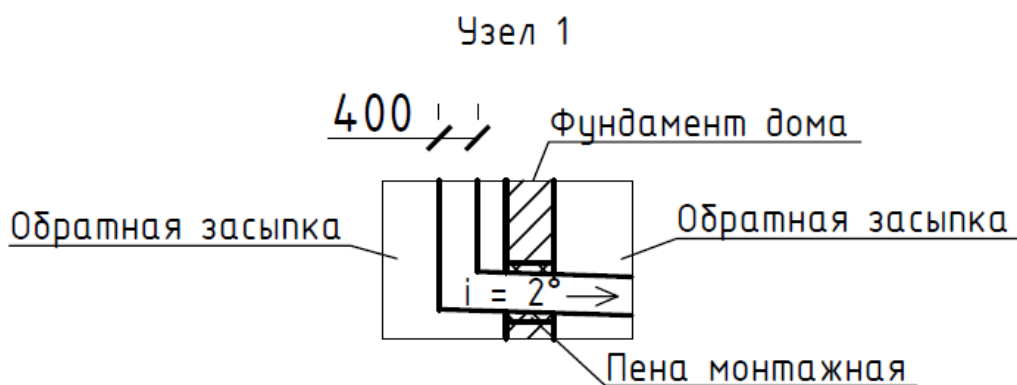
Вариант устройства канального (трубного) теплообменника совместно с фундаментом здания. Узел 1
